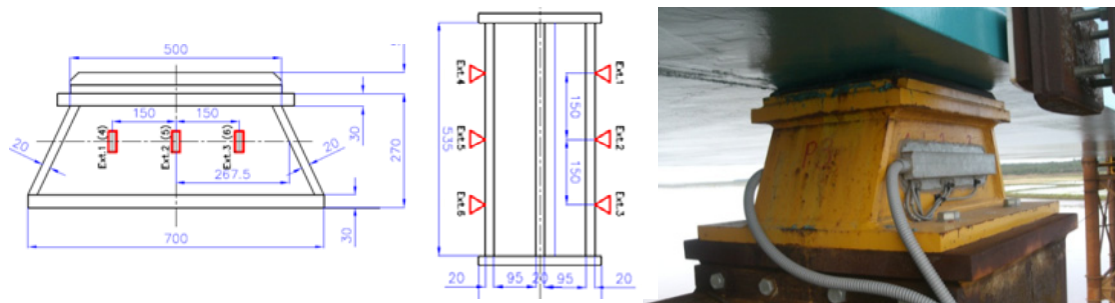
Aparelho de apoio provisório instrumentado (pilar P3).
